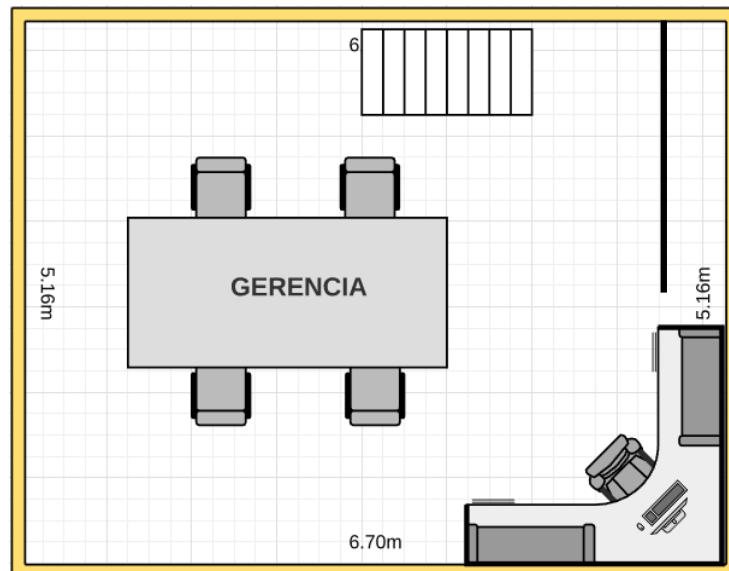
Plano de red segundo piso. Fuente: Autor
